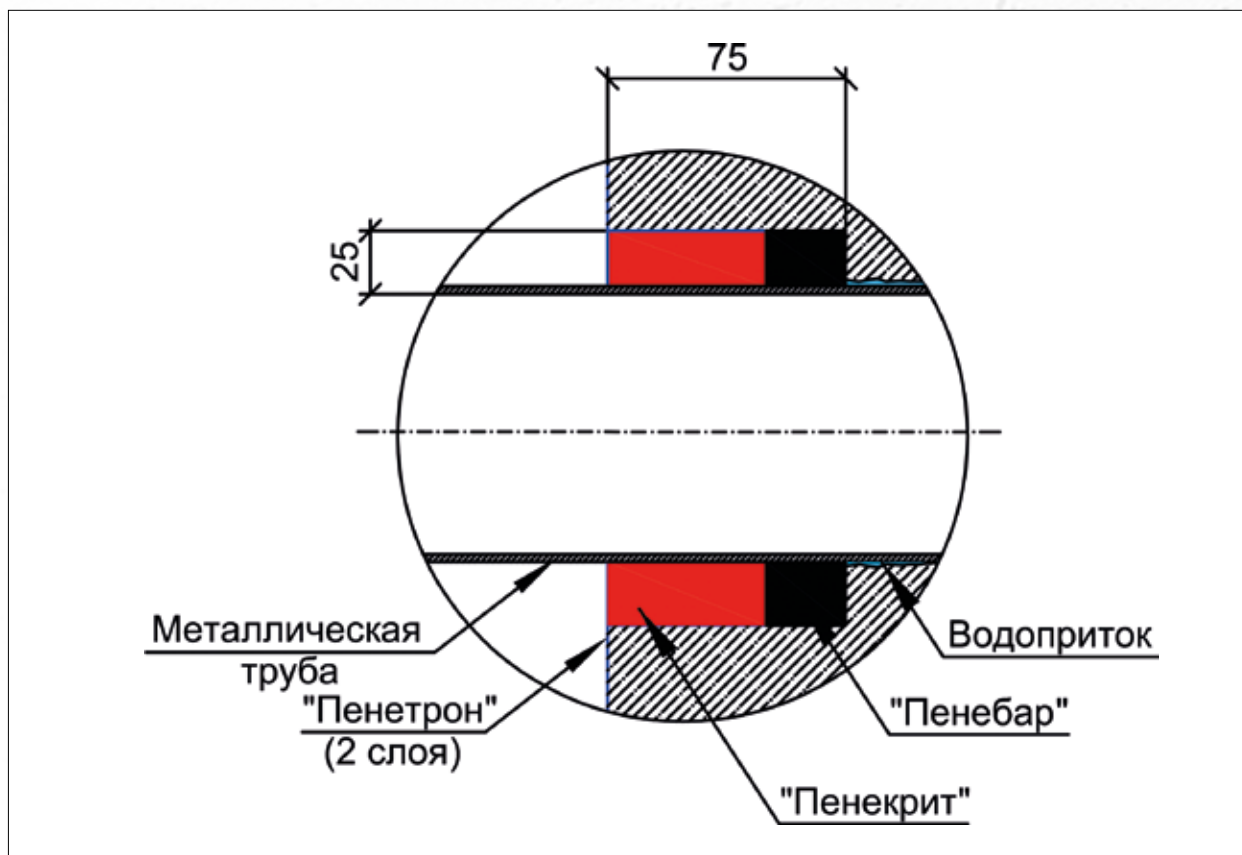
Гидроизоляция примыкания металлической гильзы к бетону
